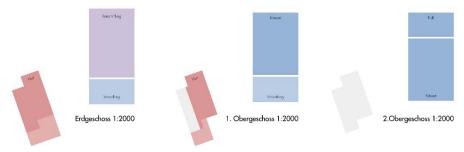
Piktografische Darstellung des Grundrisses
